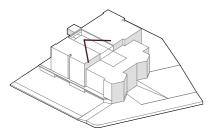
VISTA EXTERIOR DESDE PLAZA PRINCIPAL
